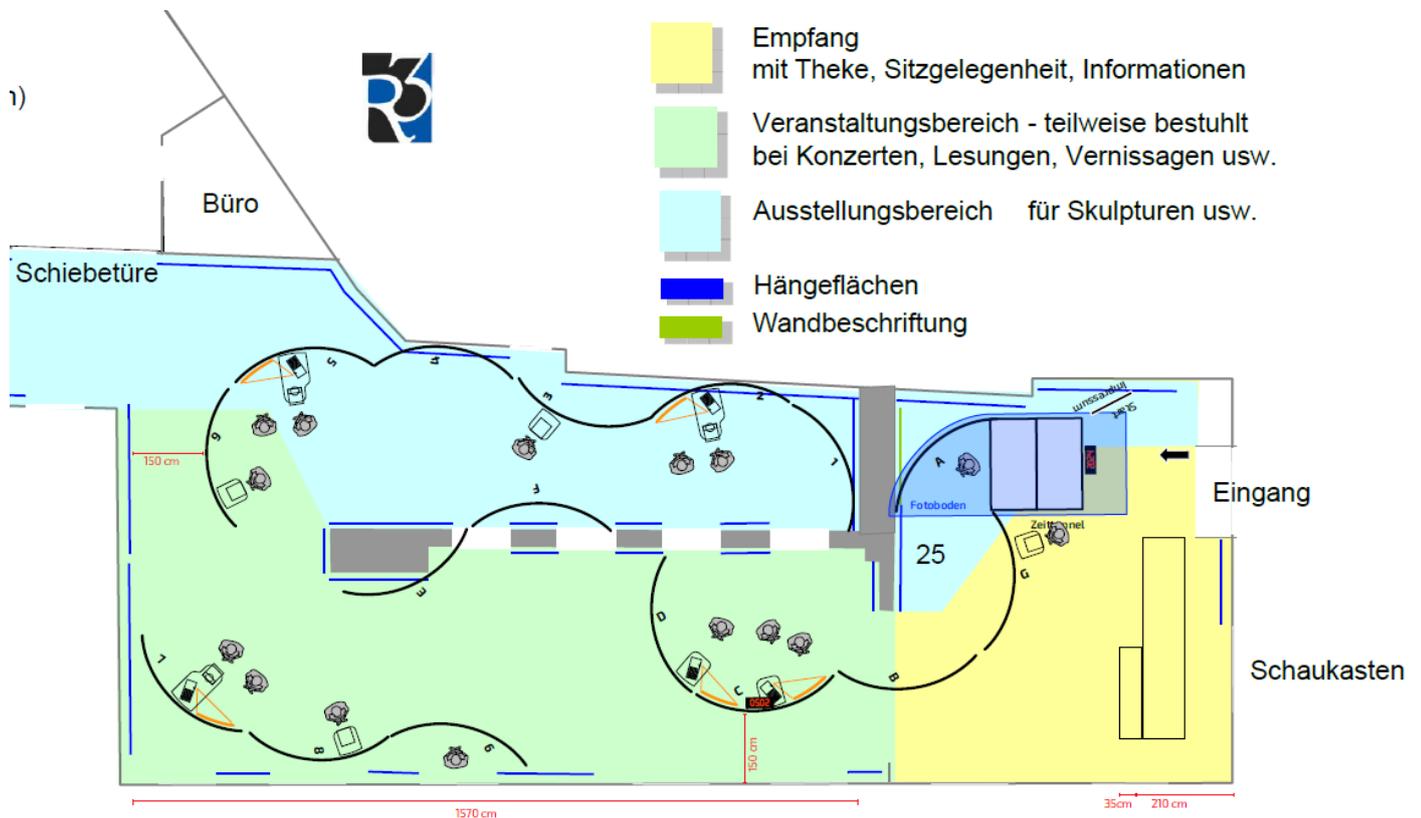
Grundriss Futur II im Kulturforum Ansbach © hof3
